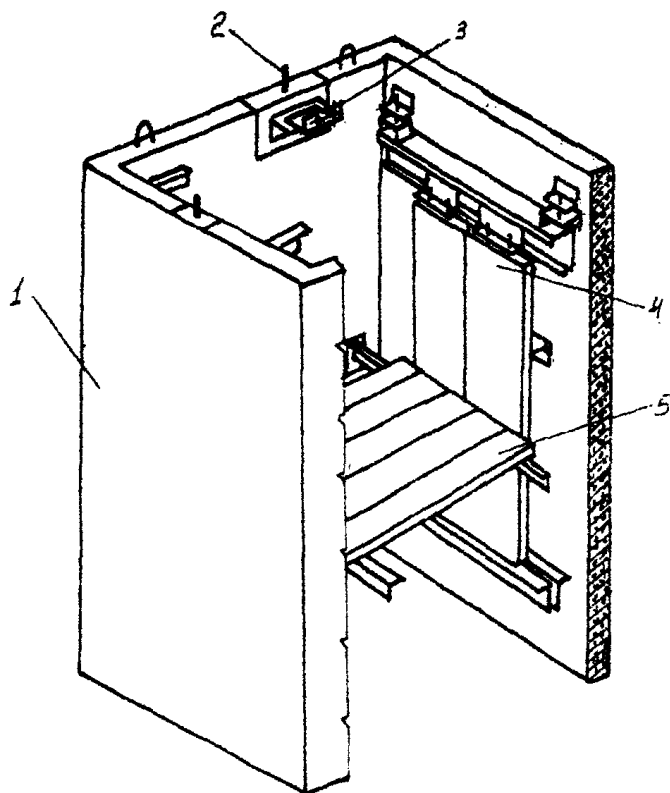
Тюбинг шахты; оснащенный оборудованием лифта:
